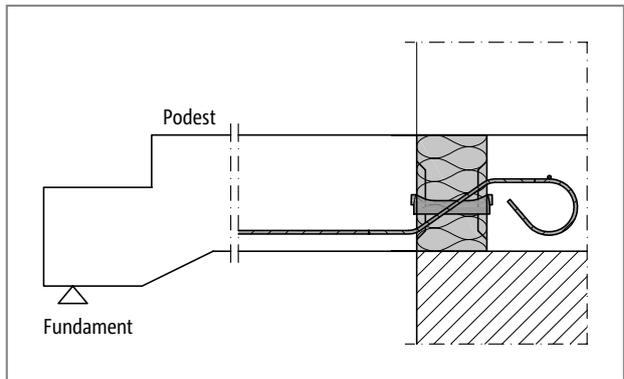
Schöck Isokorb® Typ QXT: Anschluss Treppenpodest bei einschaligem, wärmedämmendem Mauerwerk (Typ QXT10 bis QXT40)
